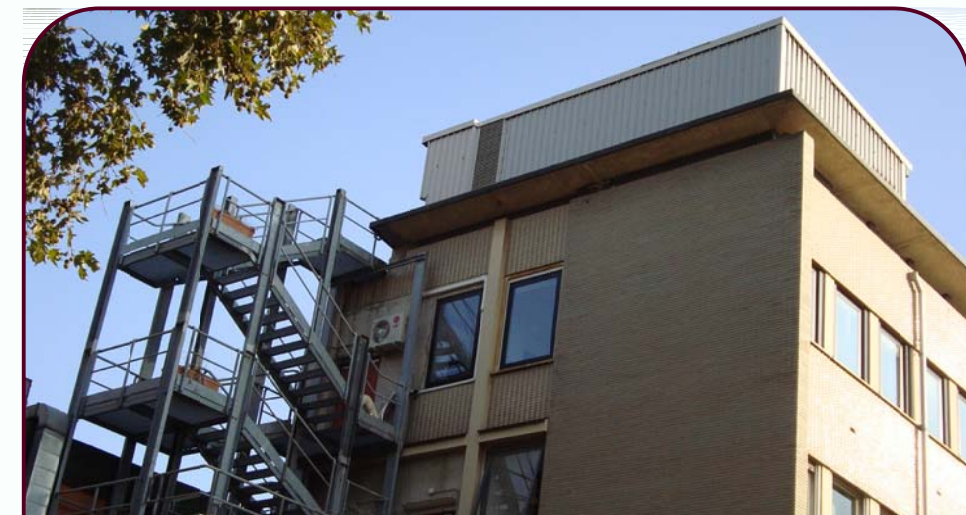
Prospetto Nord scala esterna di collegamento in facciata
